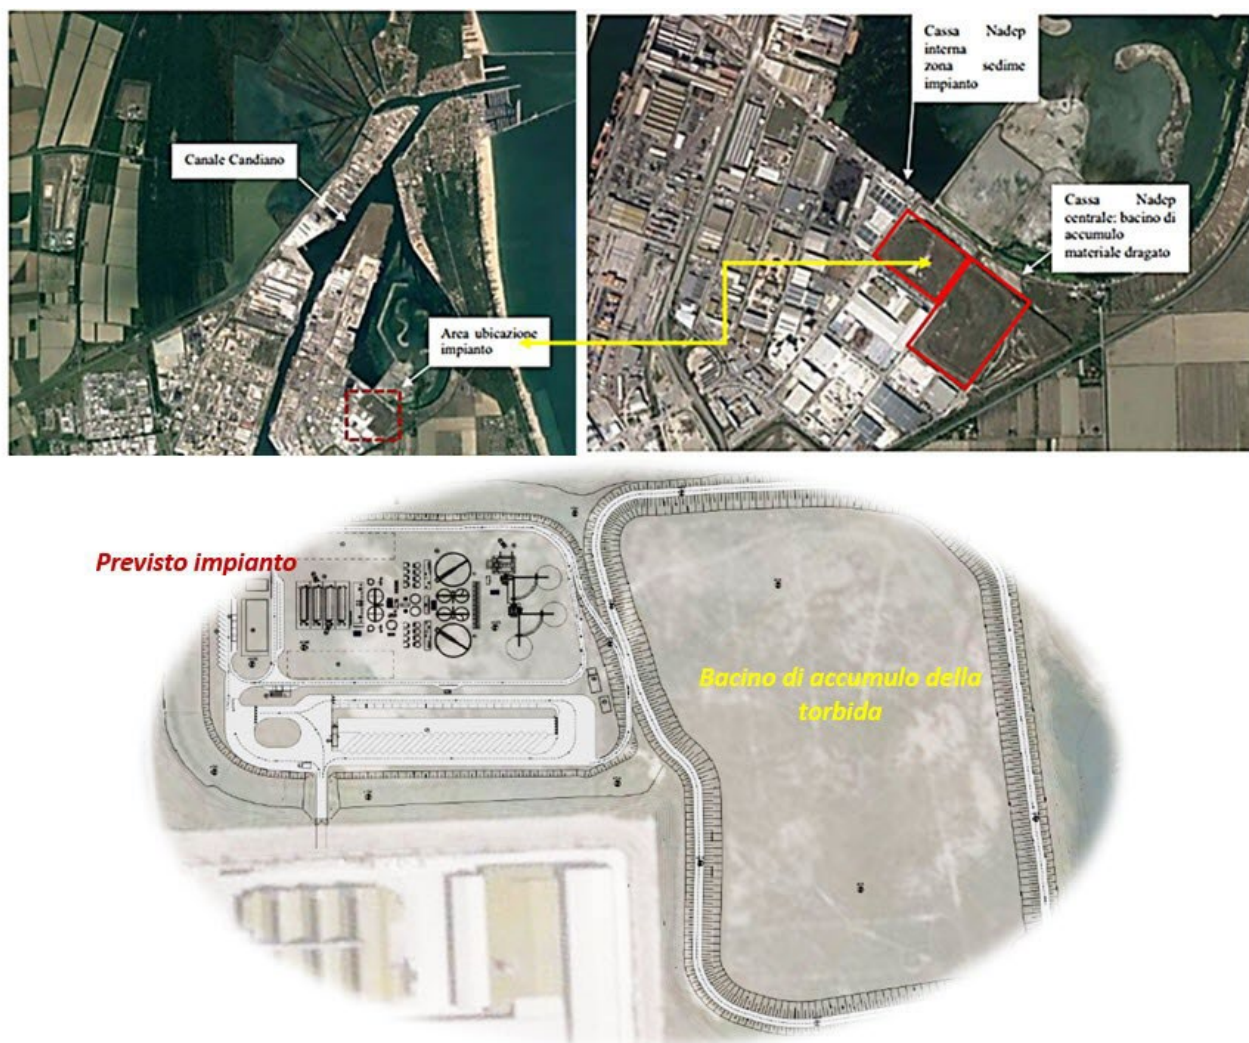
Inquadramento ed ubicazione della zona di previsto progetto nell'ambito portuale ravennate
